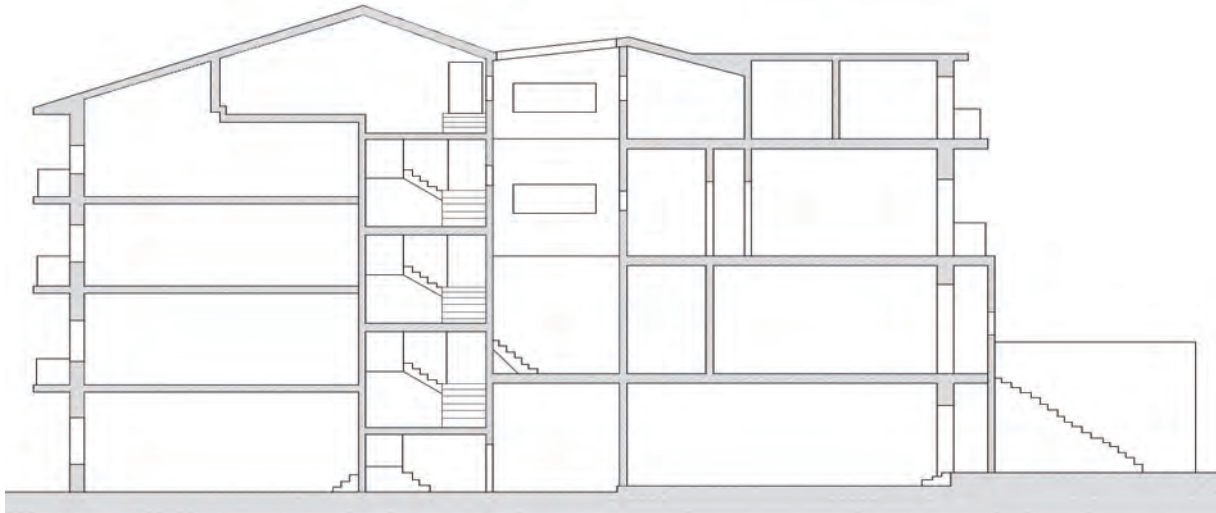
12. SECCIÓN LONGITUDINAL
